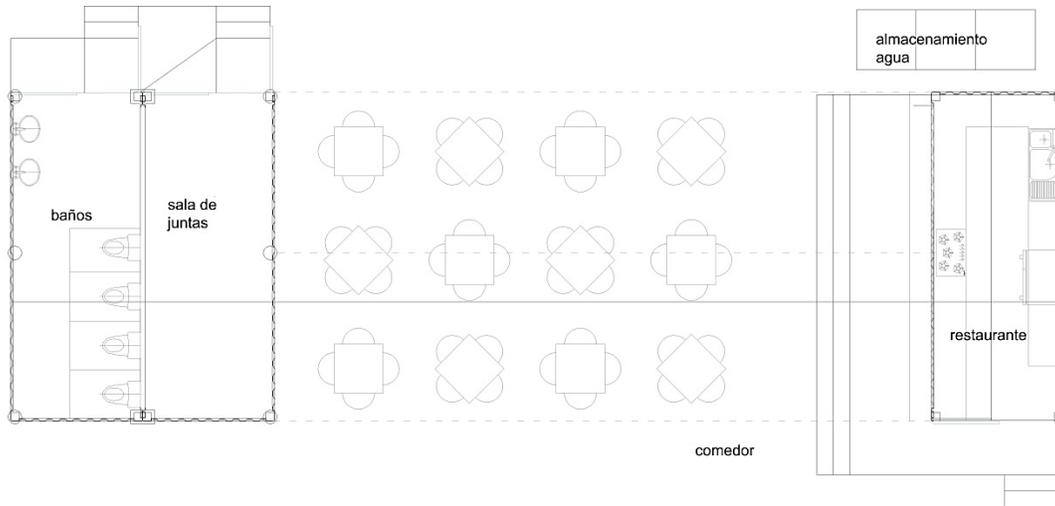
Planta de restaurante y sala de juntas, Núcleo 2
